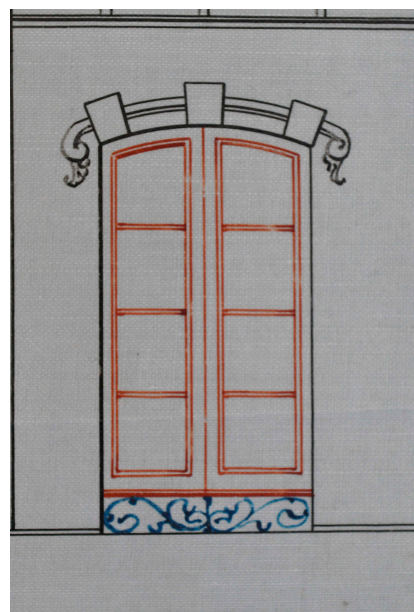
Remate de jambas. Unid. Instal 76-95. Archivo S/C Tfe. Arqto. Otilio Arroyo. Foto: el autor.
